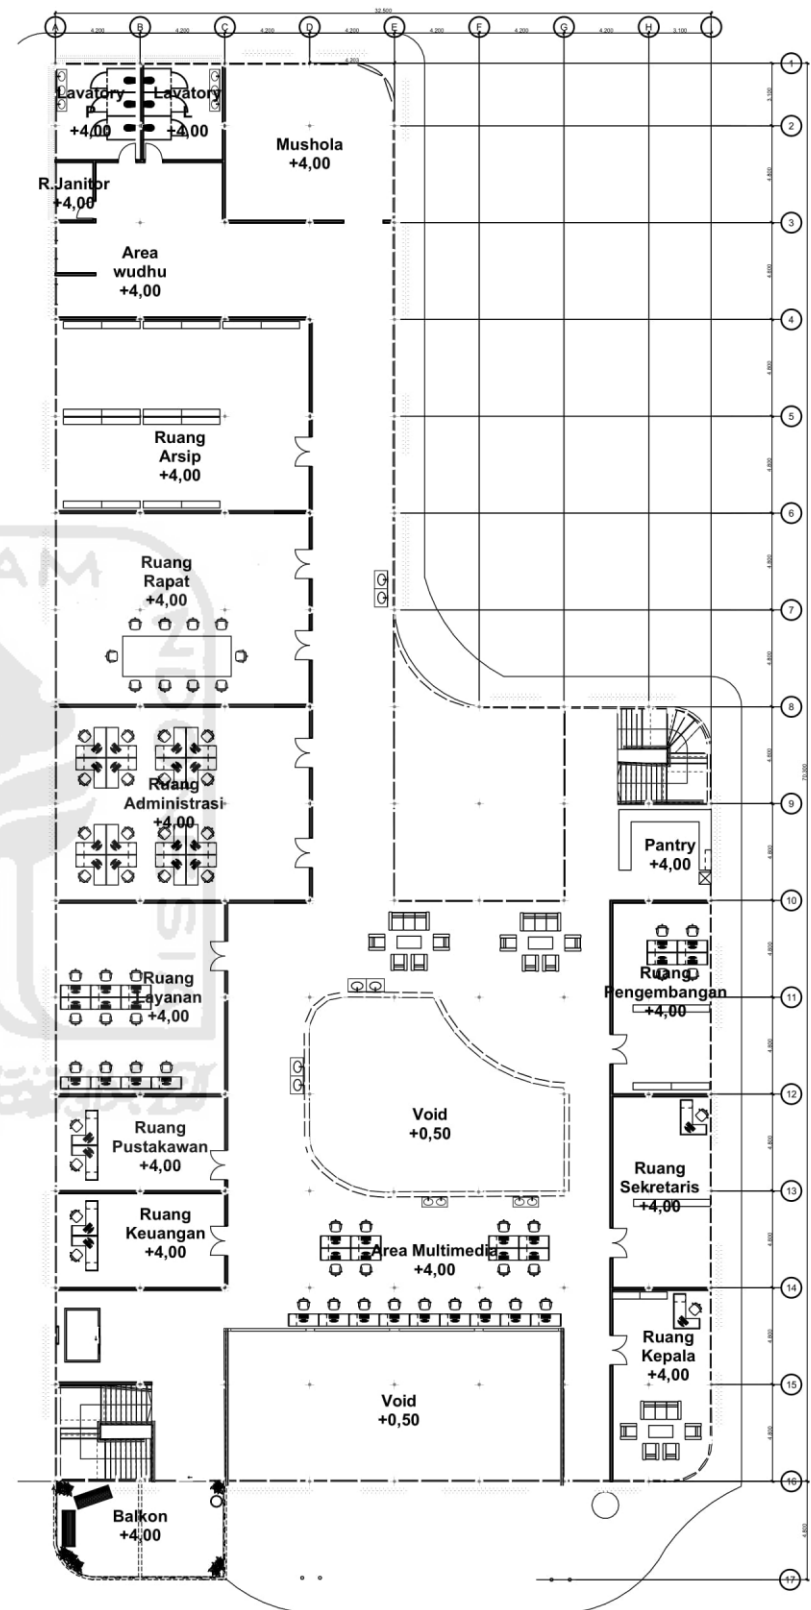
Denah Bangunan Perpustakaan sebelum dan sesudah
